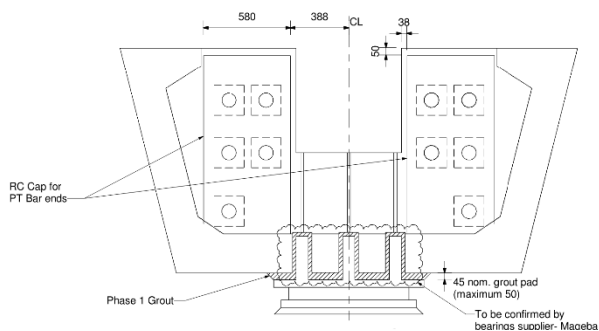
Sección transversal de la viga artesa en sección de apoyos, con los huecos horizontales en diafragmas para las barras de pretensado y huecos verticales para los pernos de los aparatos de apoyo.
